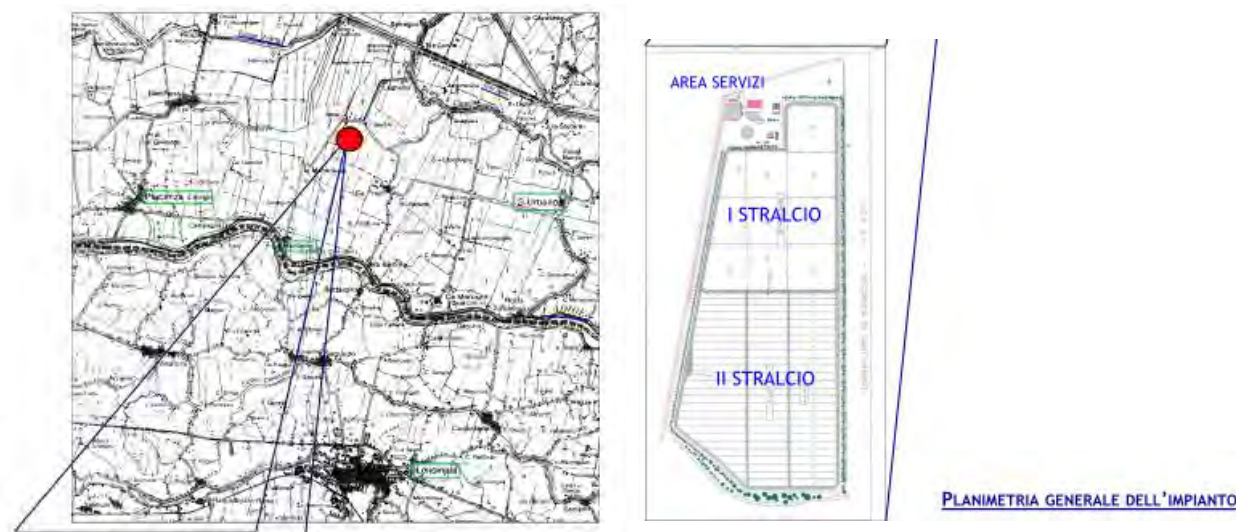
Ubicazione della discarica di Sat'Urbano e planimetria generale dell'impianto
